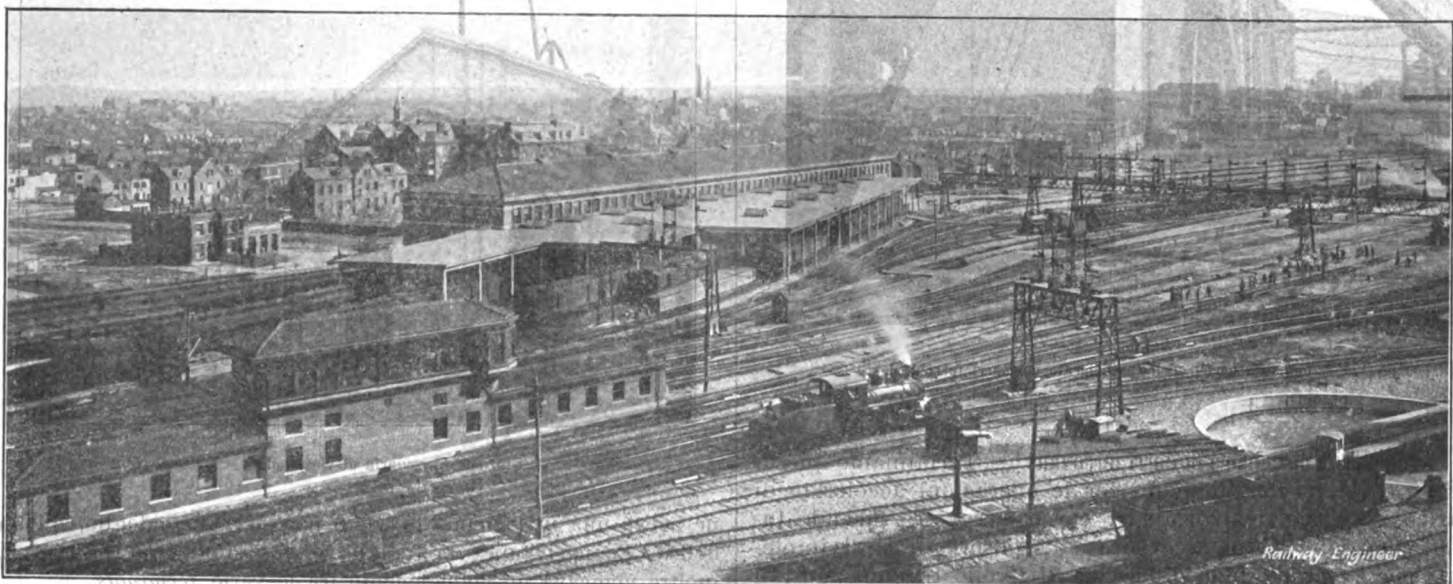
Stazione ferroviaria di Washington. - Estremità sud del piazzale.
